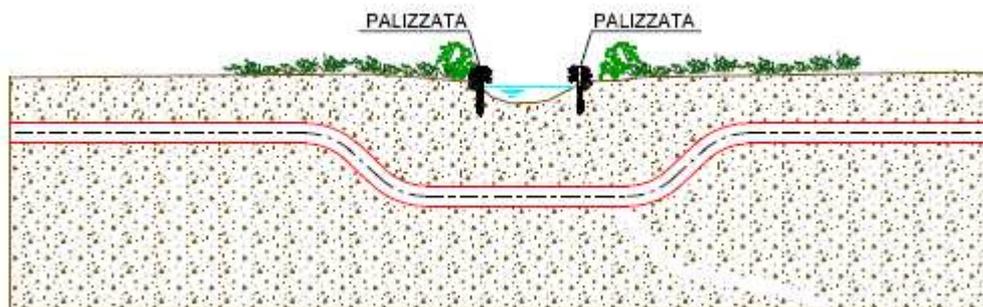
Attraversamento fosso Caracciolo - Sezione schematica di progetto
